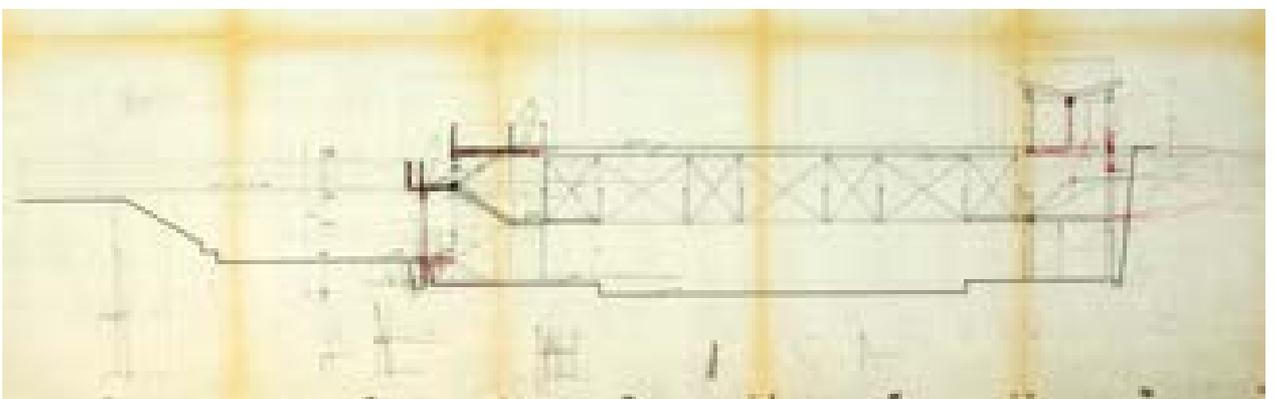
Sezione XX, studi su tavola – stato futuro - s.d. (AABS-95.461)
